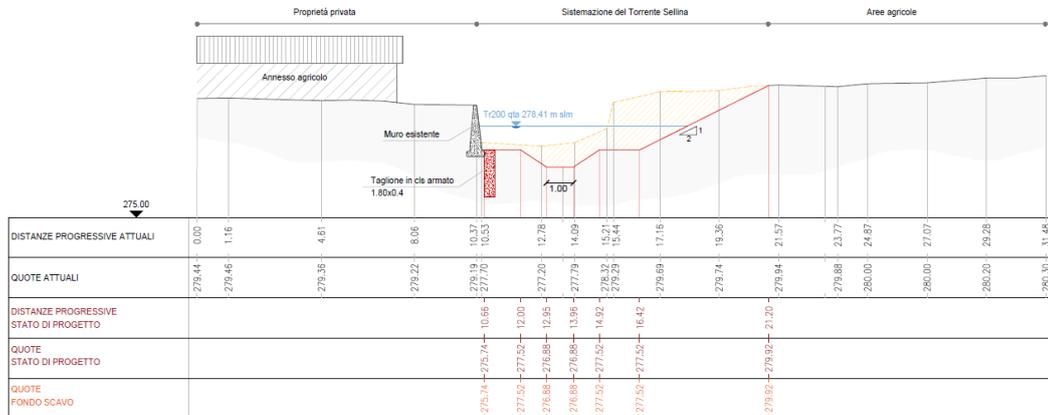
estratto della tavola T03a del progetto - Sezione 2560.
